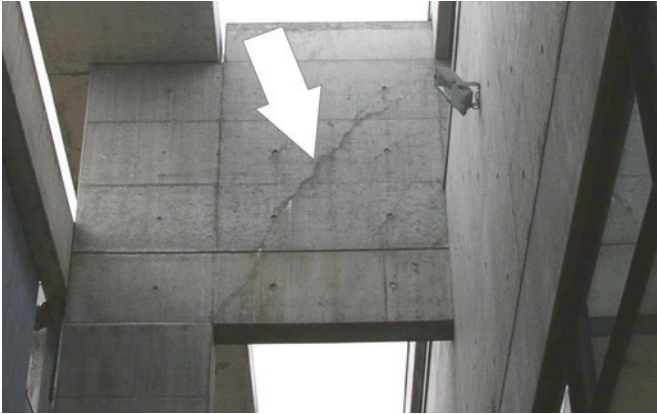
Fissure dite d'« effort tranchant » coupant une poutre en béton de grande portée.
